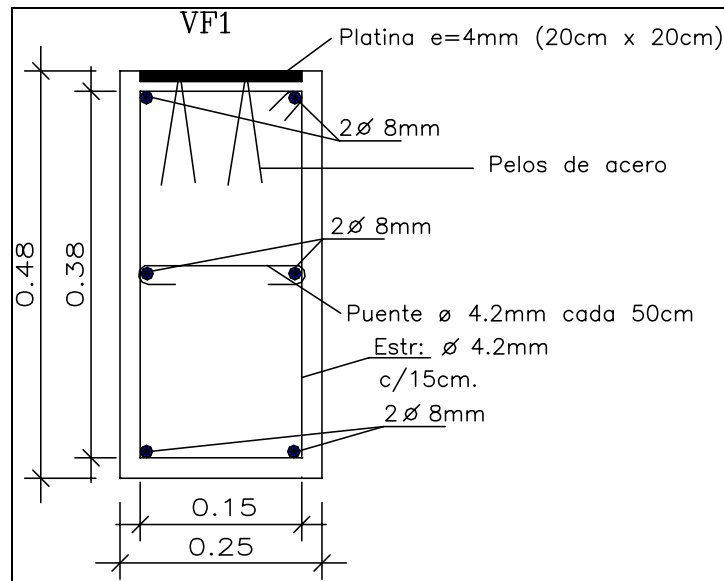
Detalle de disposición de armaduras en vigas de fundación donde arrancan las vigas metálicas de la escalera.
